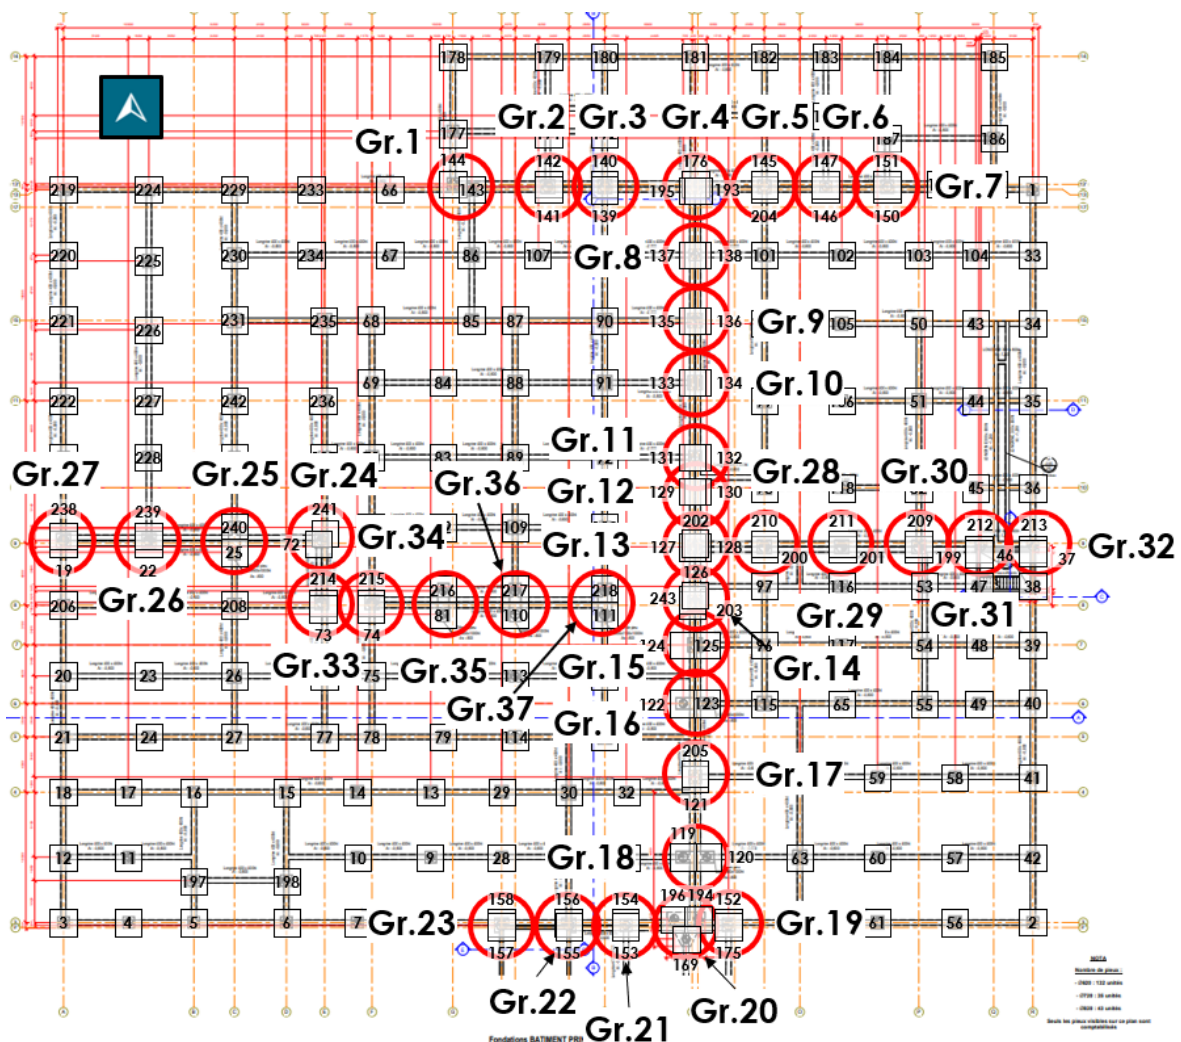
Plan de fondation du BSHE avec localisation des groupes de pieux – CEA – Sans échelle
